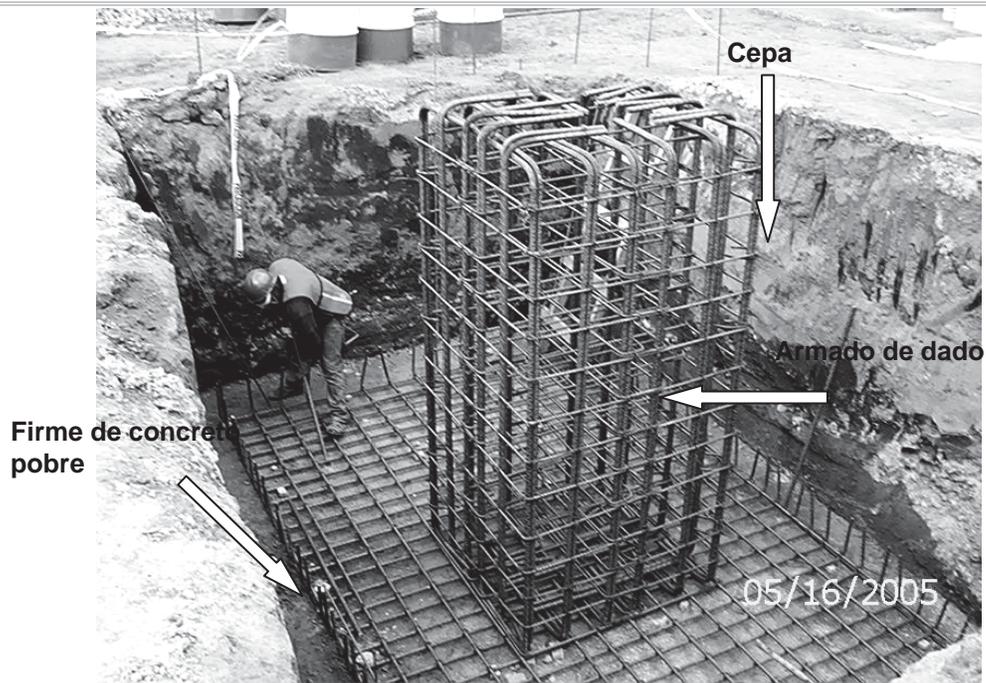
Desplante del armado sobre firme de concreto pobre.
